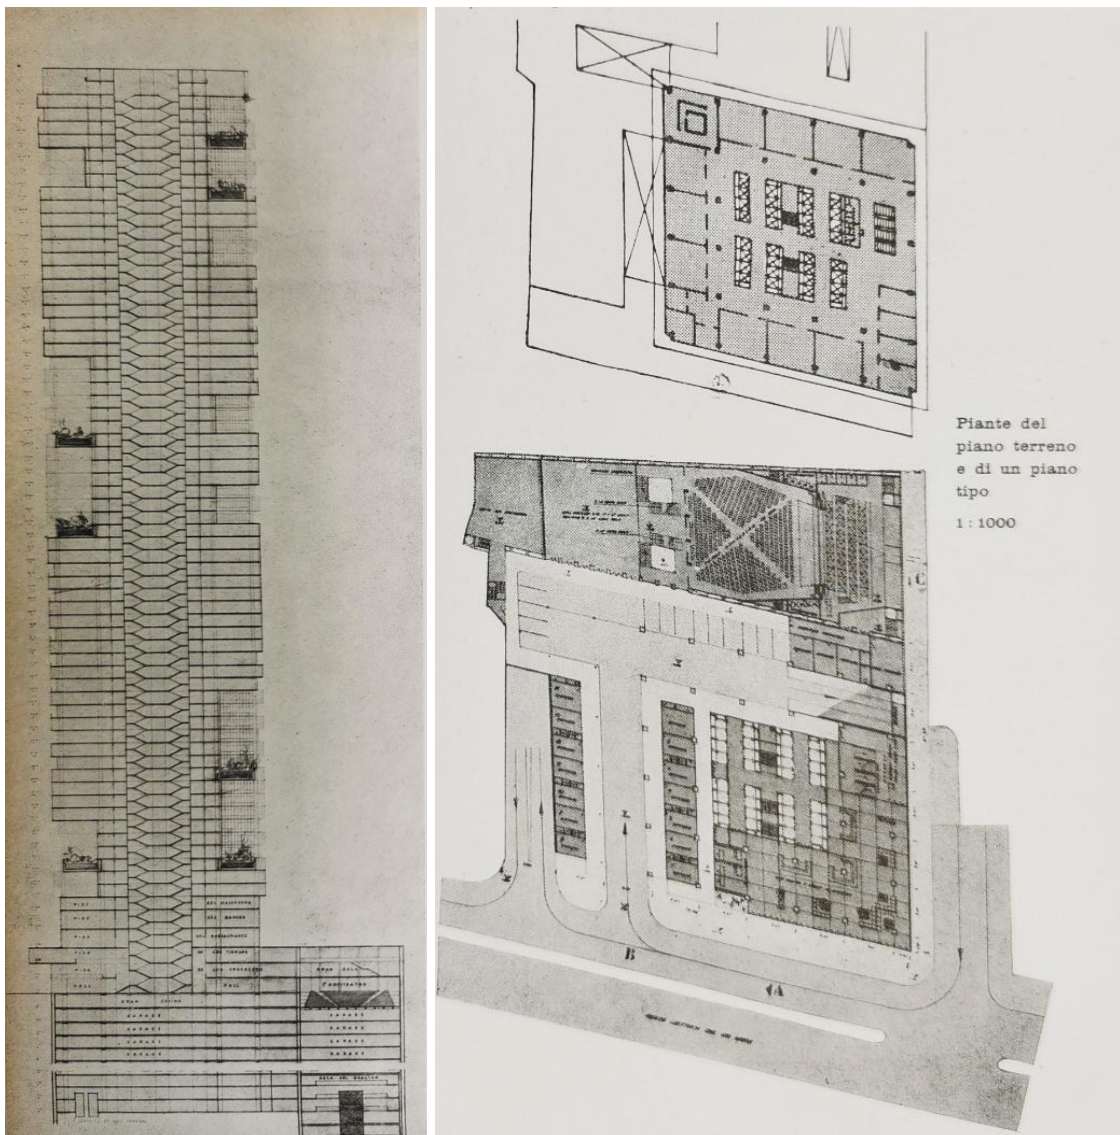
Maurizio Sacripanti, Proyecto de concurso para el Edificio Peugeot, sección y planos (planta baja y piso tipo). *Casabella-continuità*, 268, 1962.
